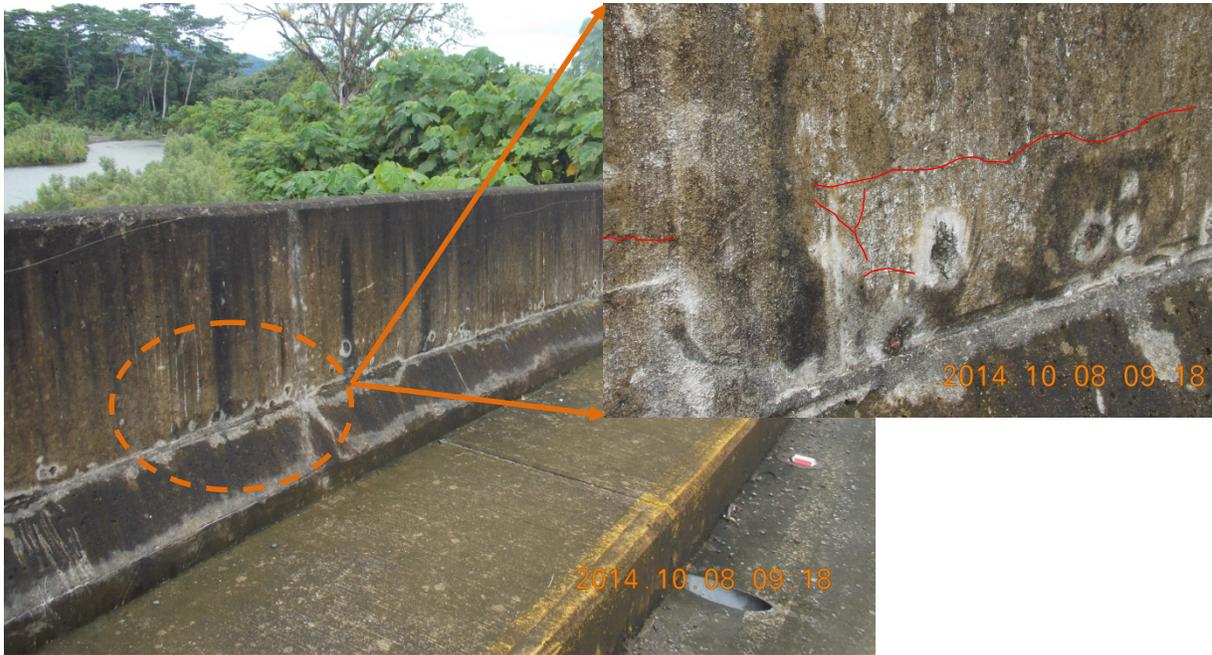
Estado de las barreras vehiculares; porosidad, grietas y agujeros en el concreto.
